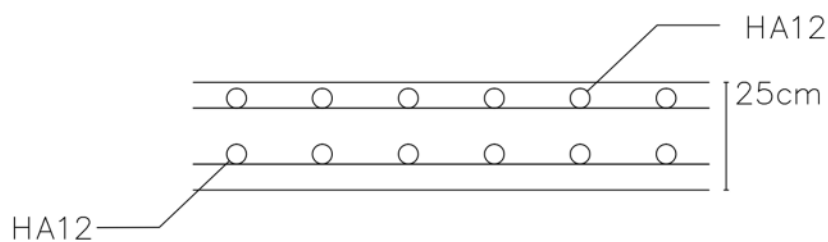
ferrailage longitudinal de l'hourdis sur ml
